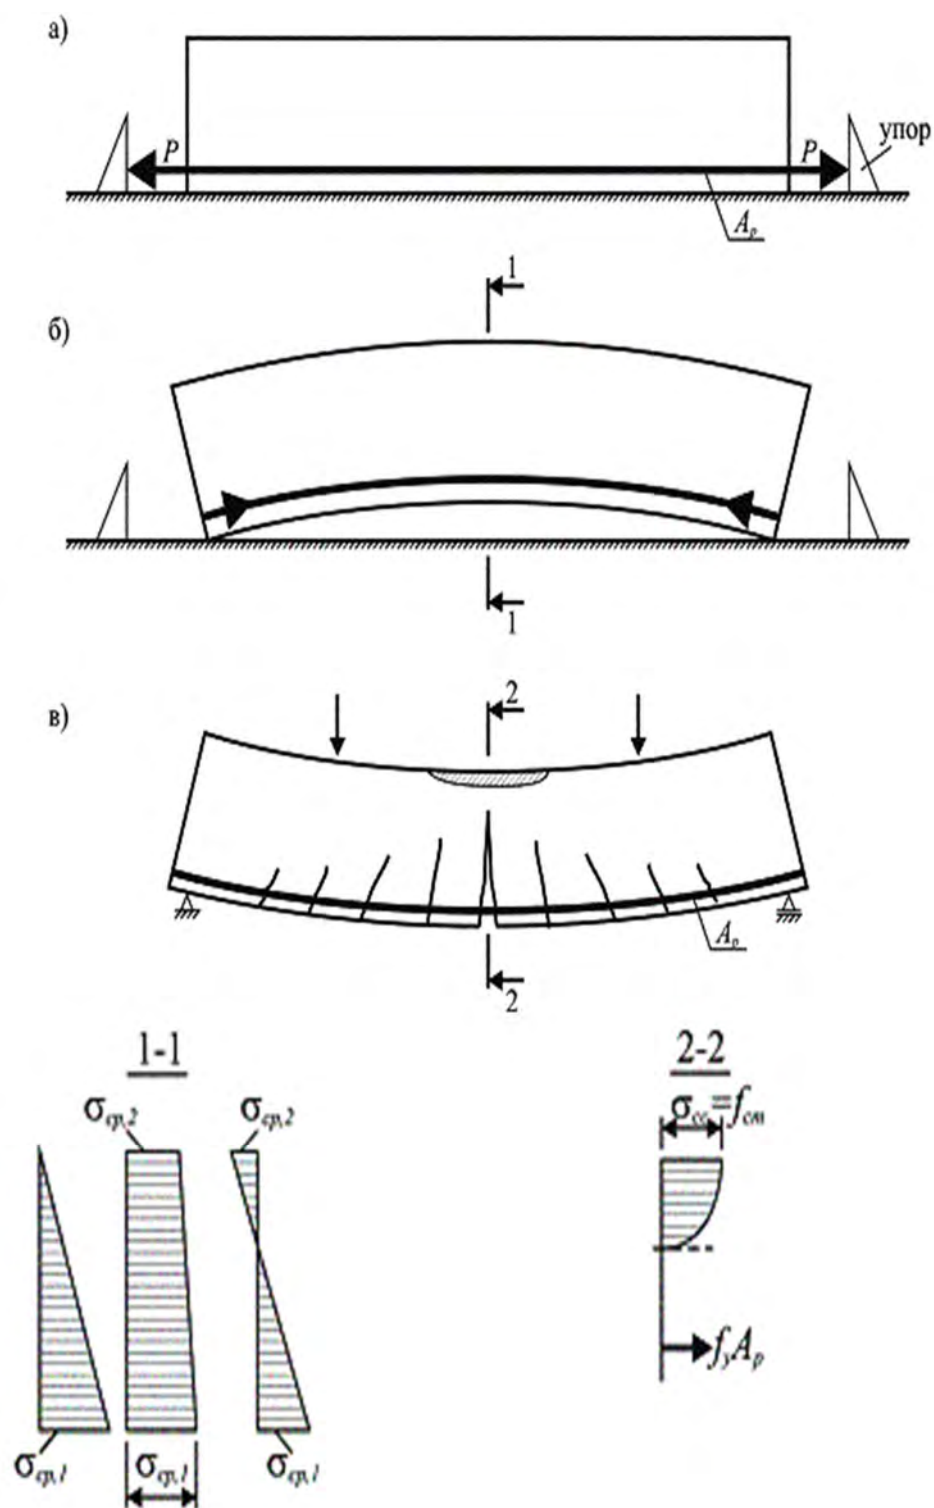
Предварительно напряженная балка при натяжении арматуры на упоры (а), возможные эпюры напряжения в бетоне после отпуска напрягаемой арматуры (б) и в стадии разрушения (в)
